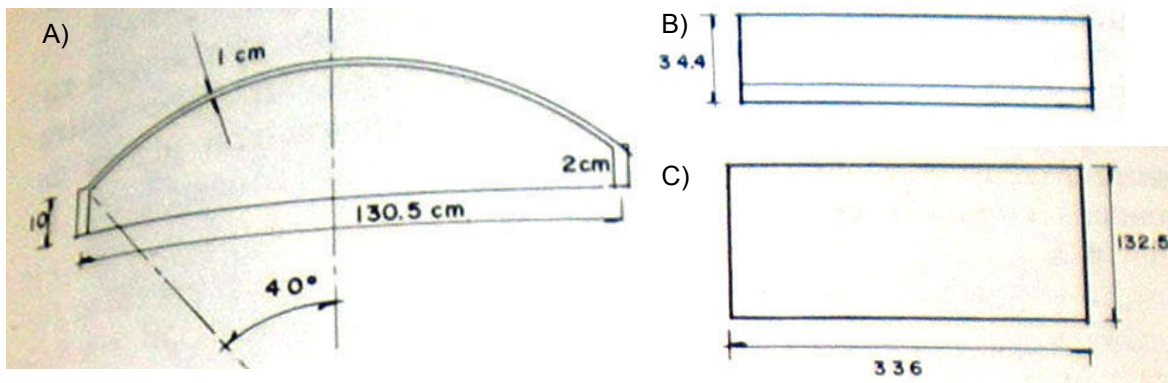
Esquema dimensional del modelo de ensayo utilizado: A) Sección transversal; B) Alzado; C) Planta. Unidades en centímetros. (10)
